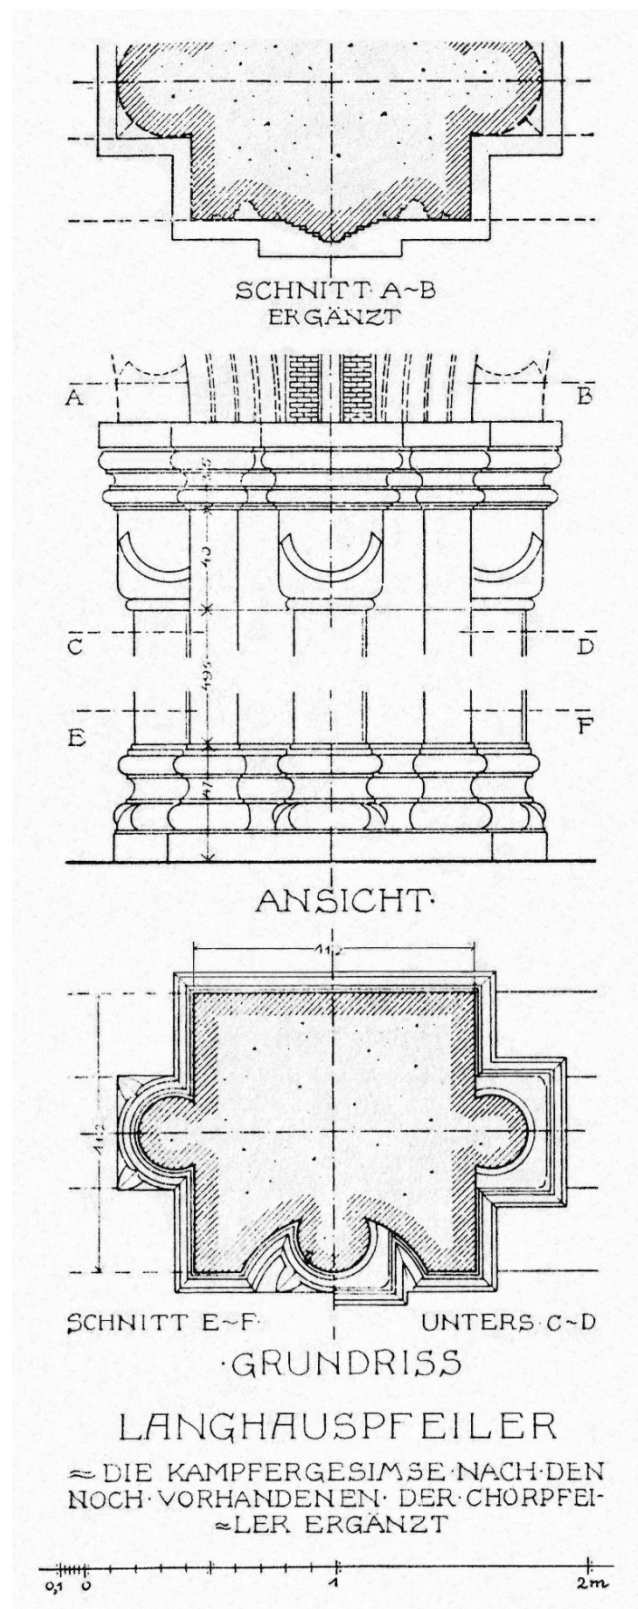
Erfurt, Peterskirche, Grundriss und Ansicht der Langhauspfeiler, nach Becker
